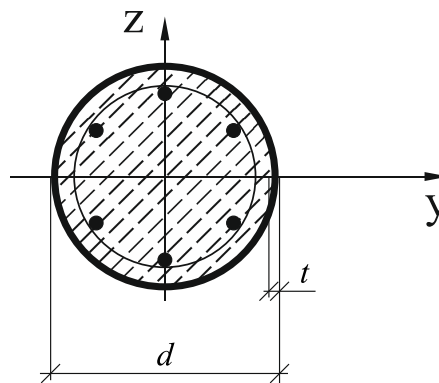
Поперечное сечение сталежелезобетонной колонны круглого сечения
